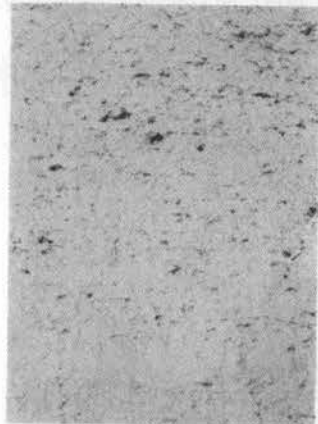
乾いていないコンクリート面は新しいコンクリートと変わらない
